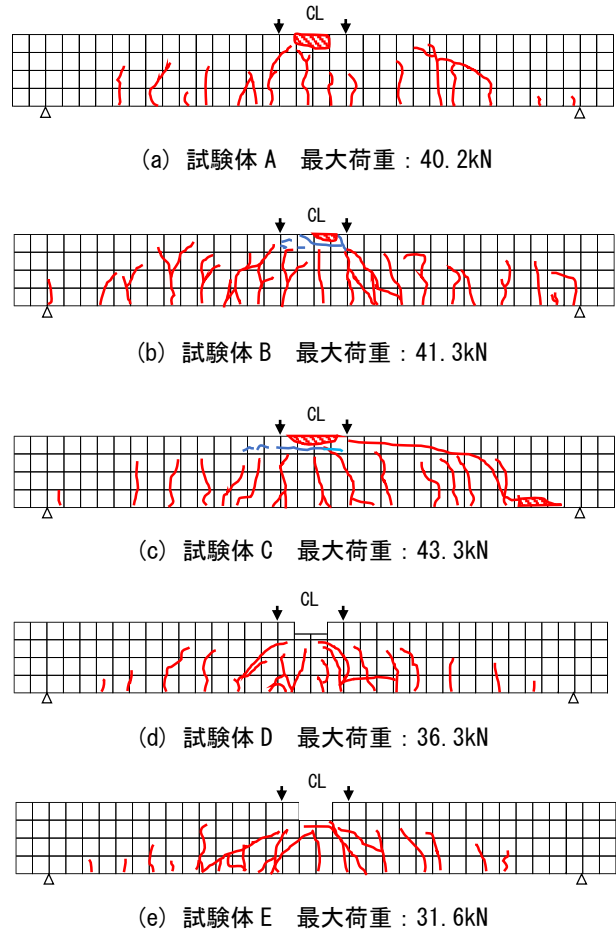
曲げ試験終了時のひび割れ発生状況
